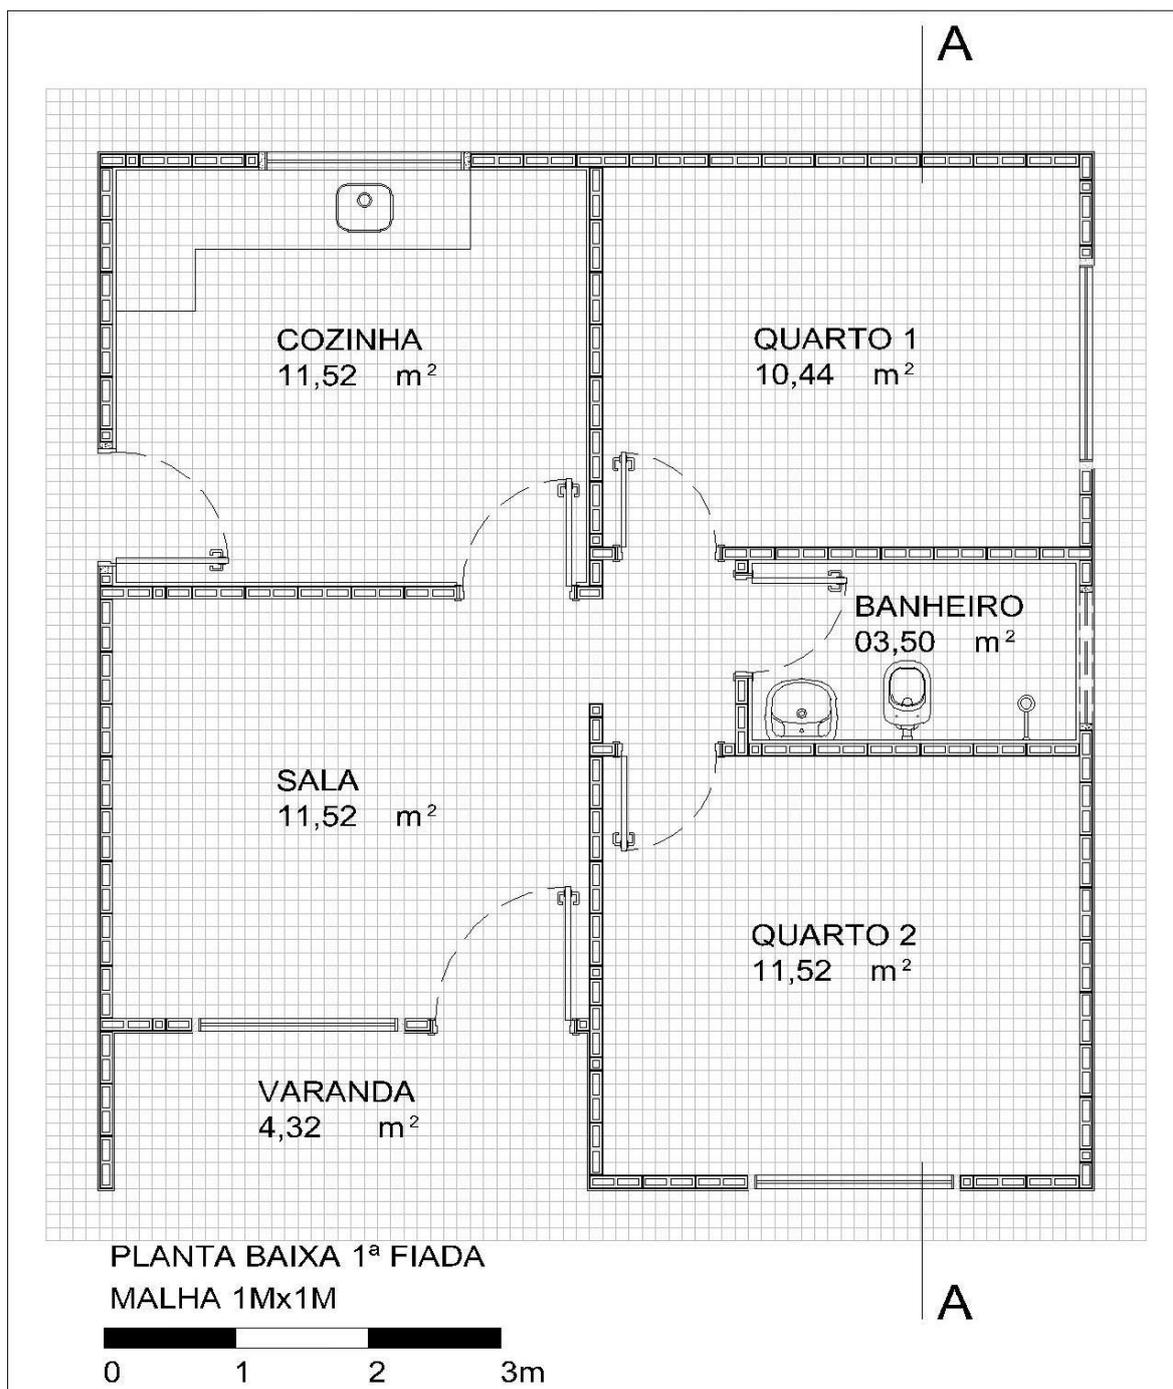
Planta Baixa 1ª fiada. Malha 1Mx1M. Fonte: desenho da autora.
